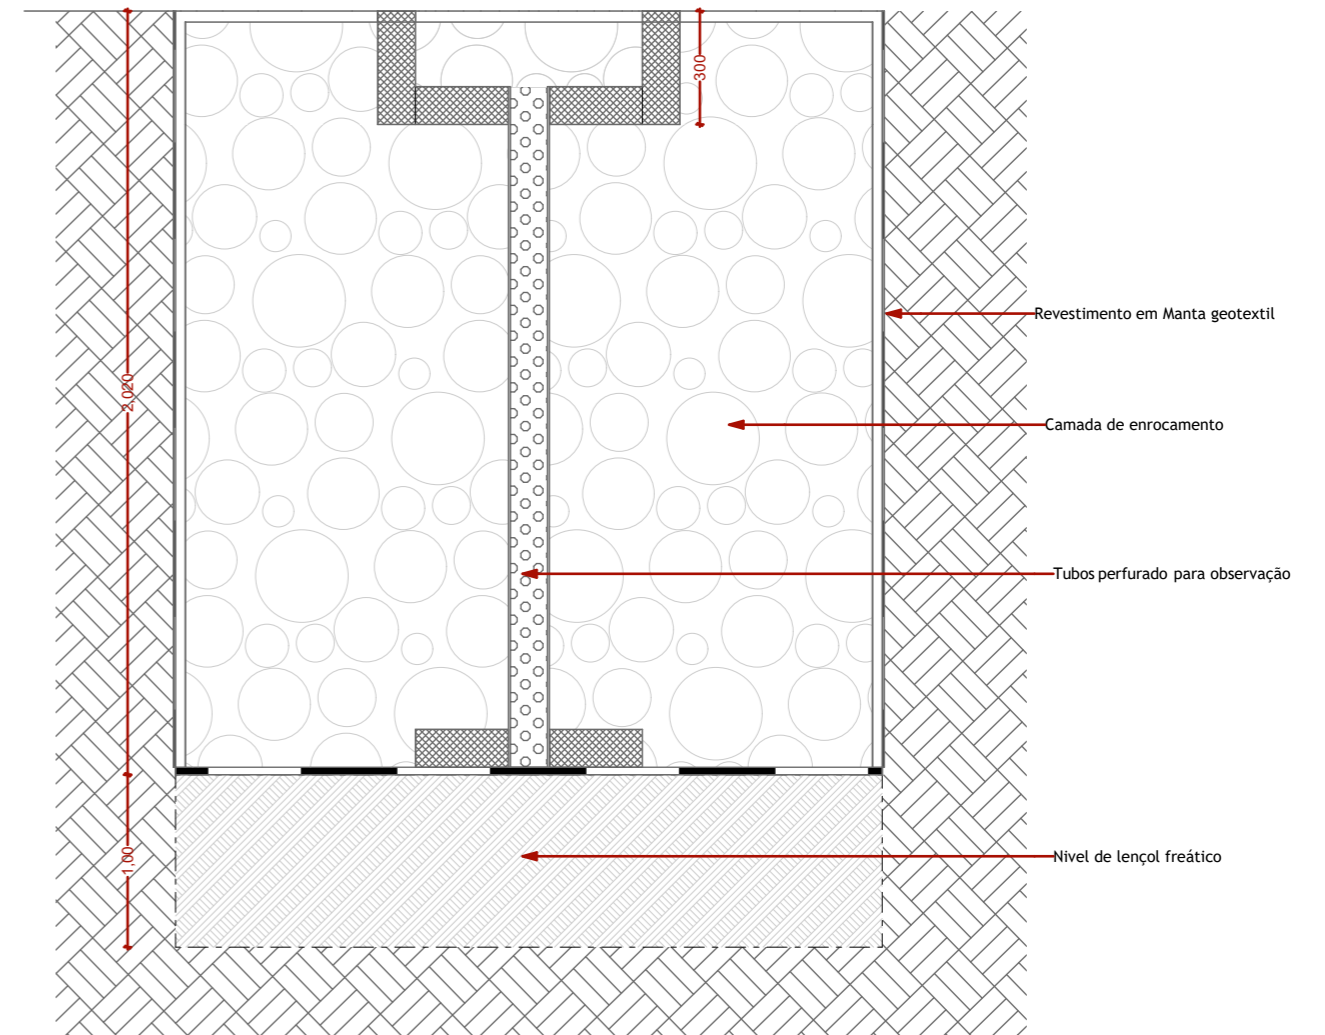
DET. CORTE TIPO DAS TRINCHEIRAS DE INFILTRAÇÃO
